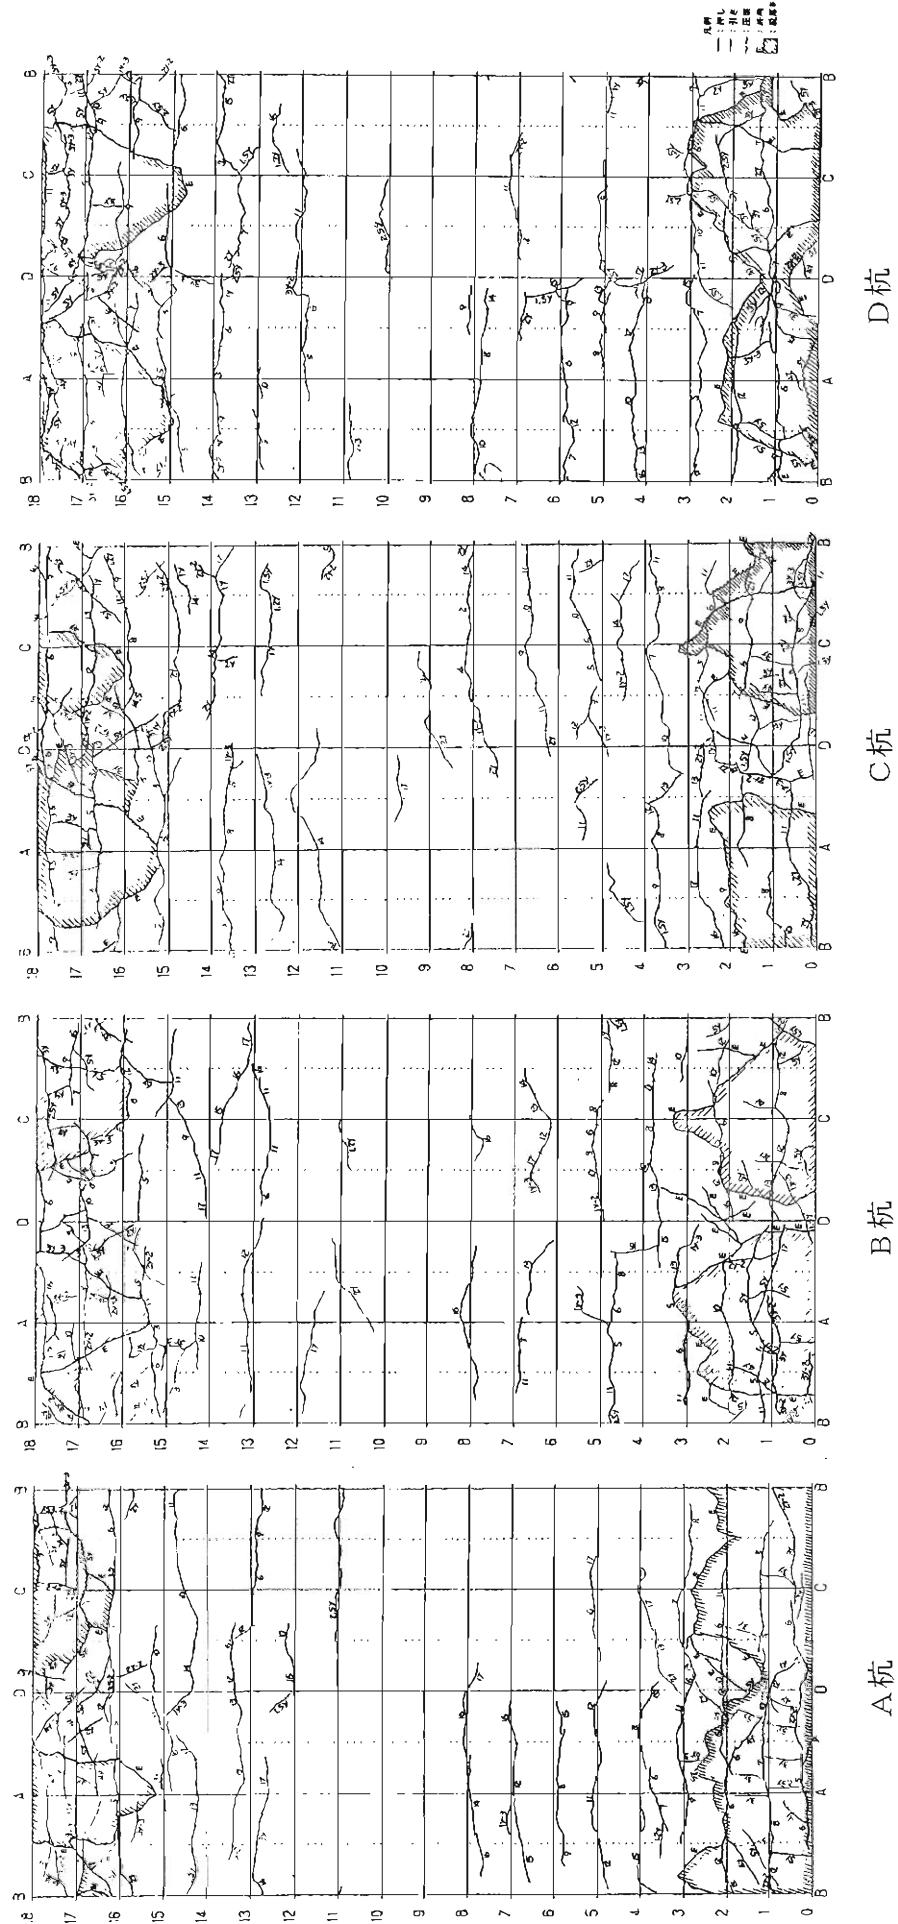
桁体のひび割れ状況展開図（ケース9、3δy）
